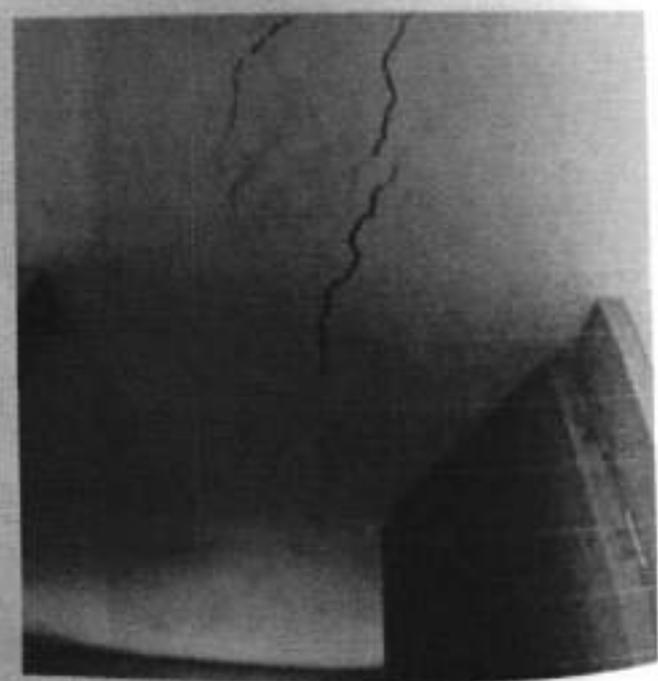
GRIETAS TECHO APTO. (2)
